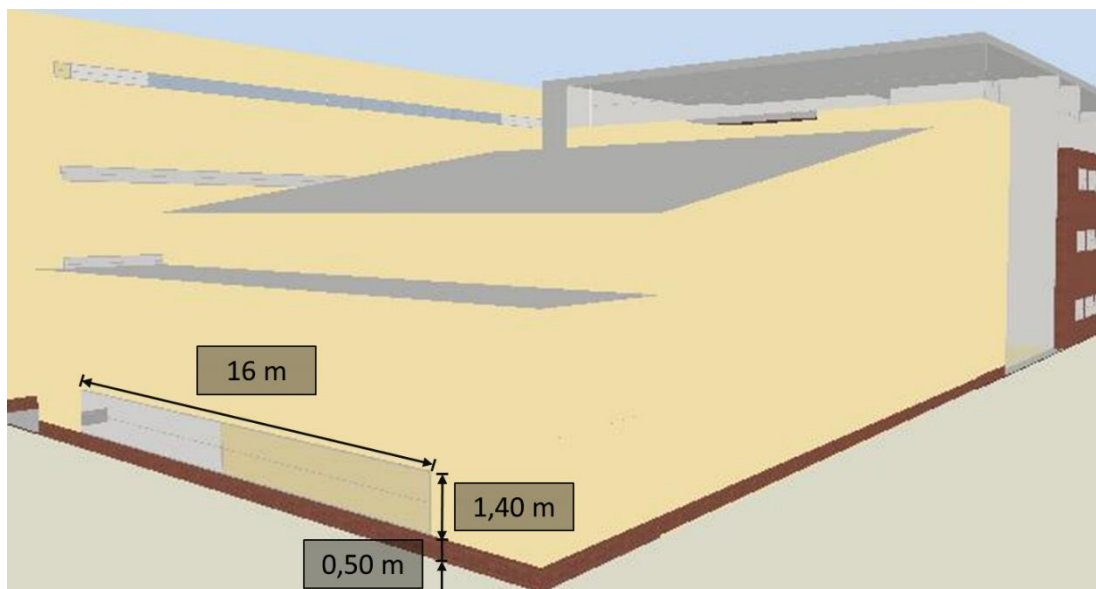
Dimensões do Vão Envidraçado da Fachada - “Aula Magna”
